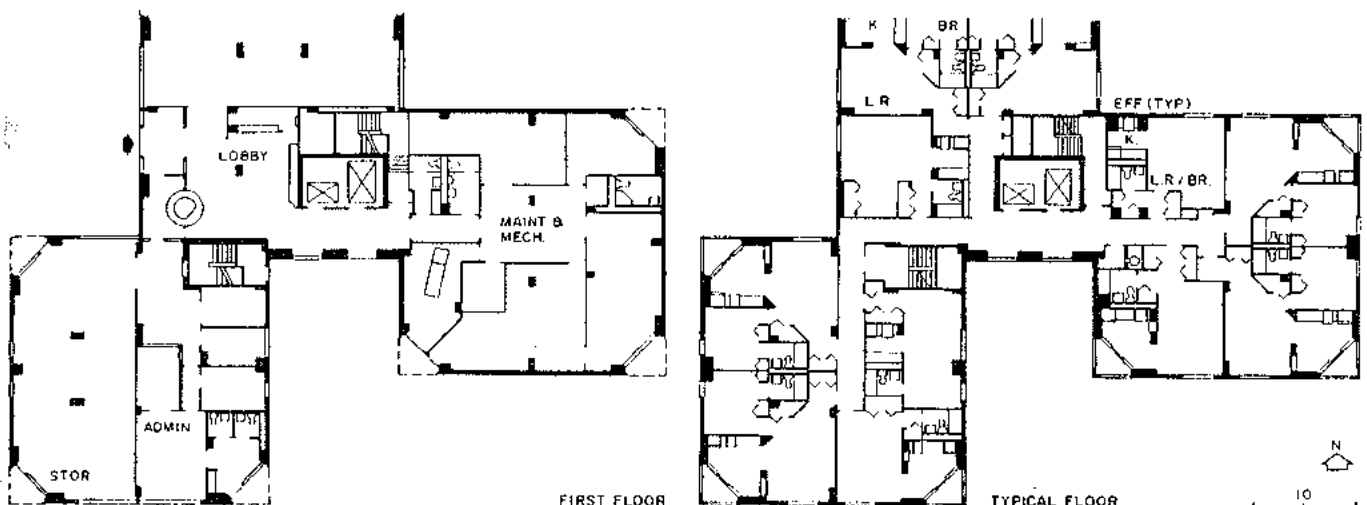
Monument East Apartment의 First Floor와 Typical Floor
